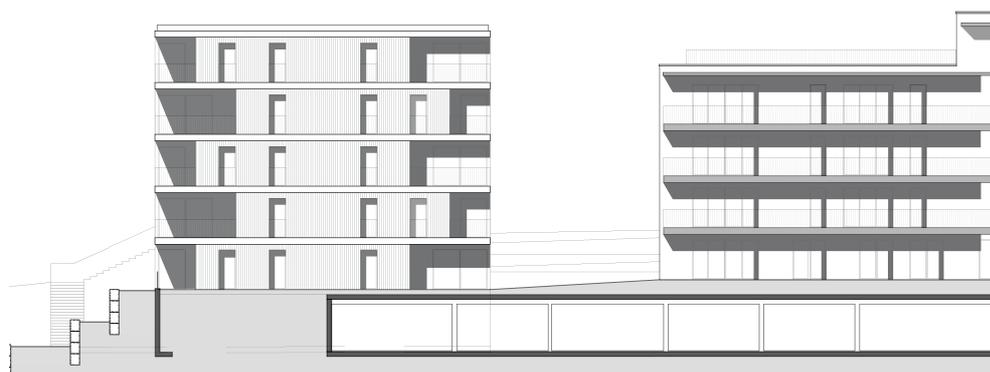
Gebäude H und C – Fassade West (Hof) [Burkhalter Architekten AG]
